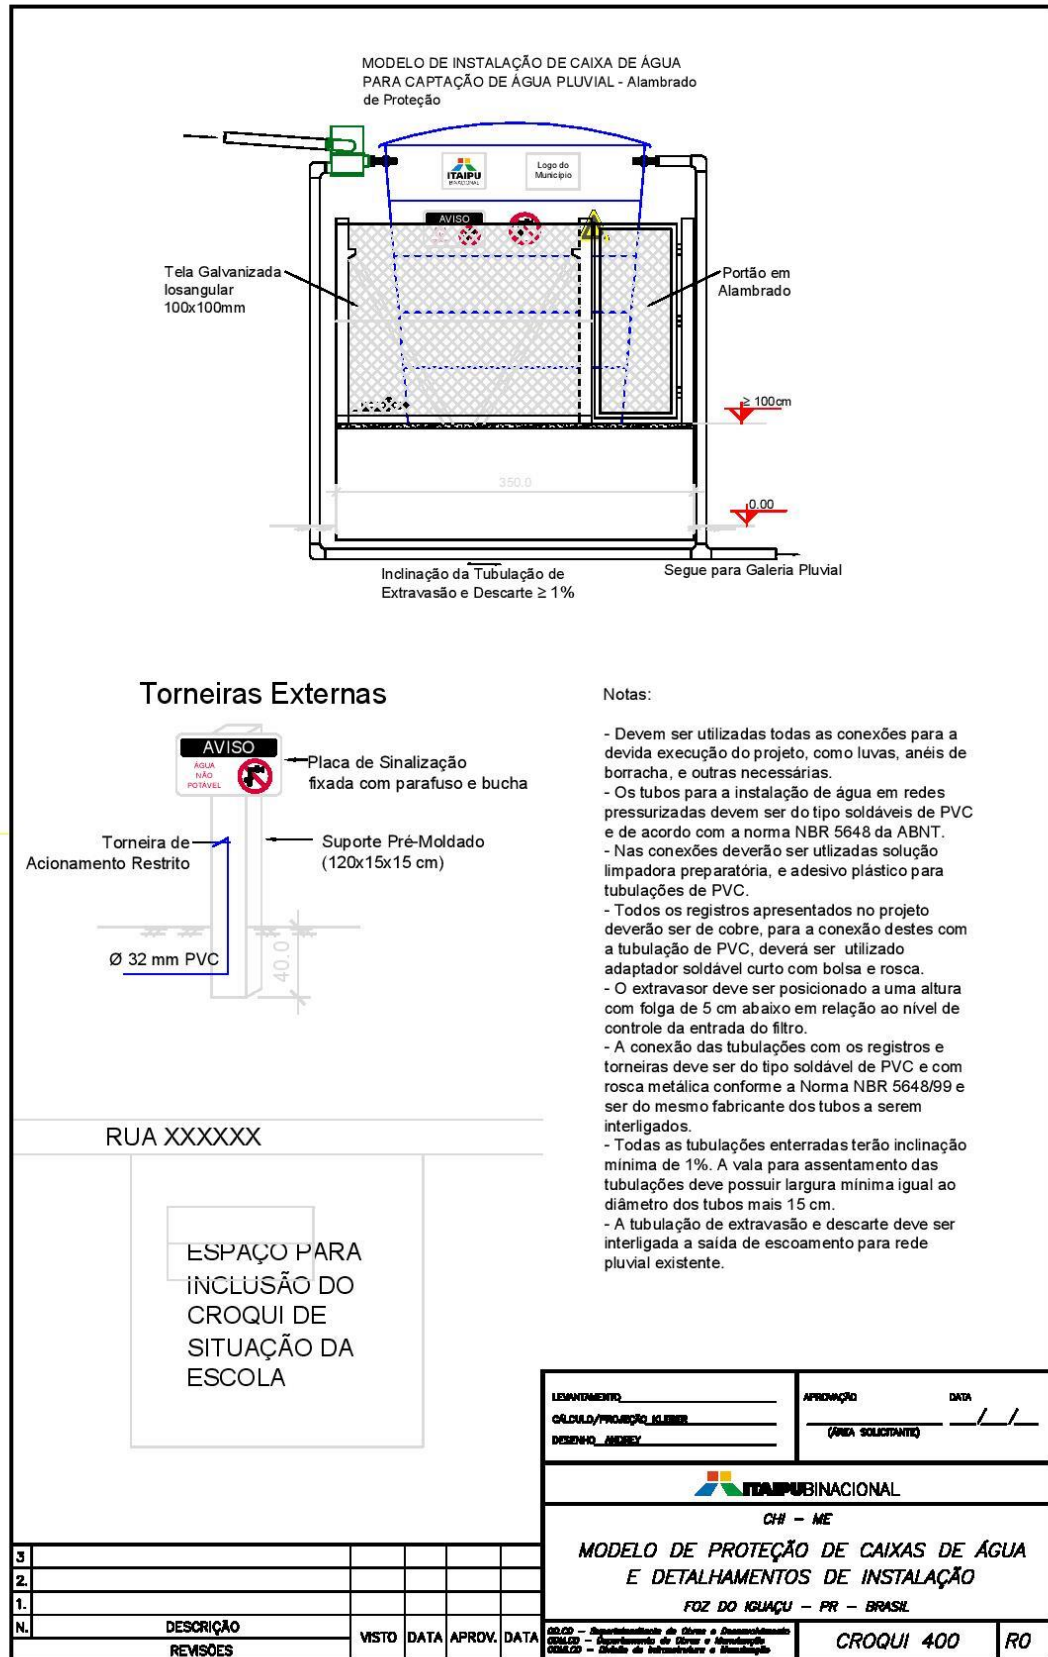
Modelo de referência de isolamento e detalhamento de instalação
